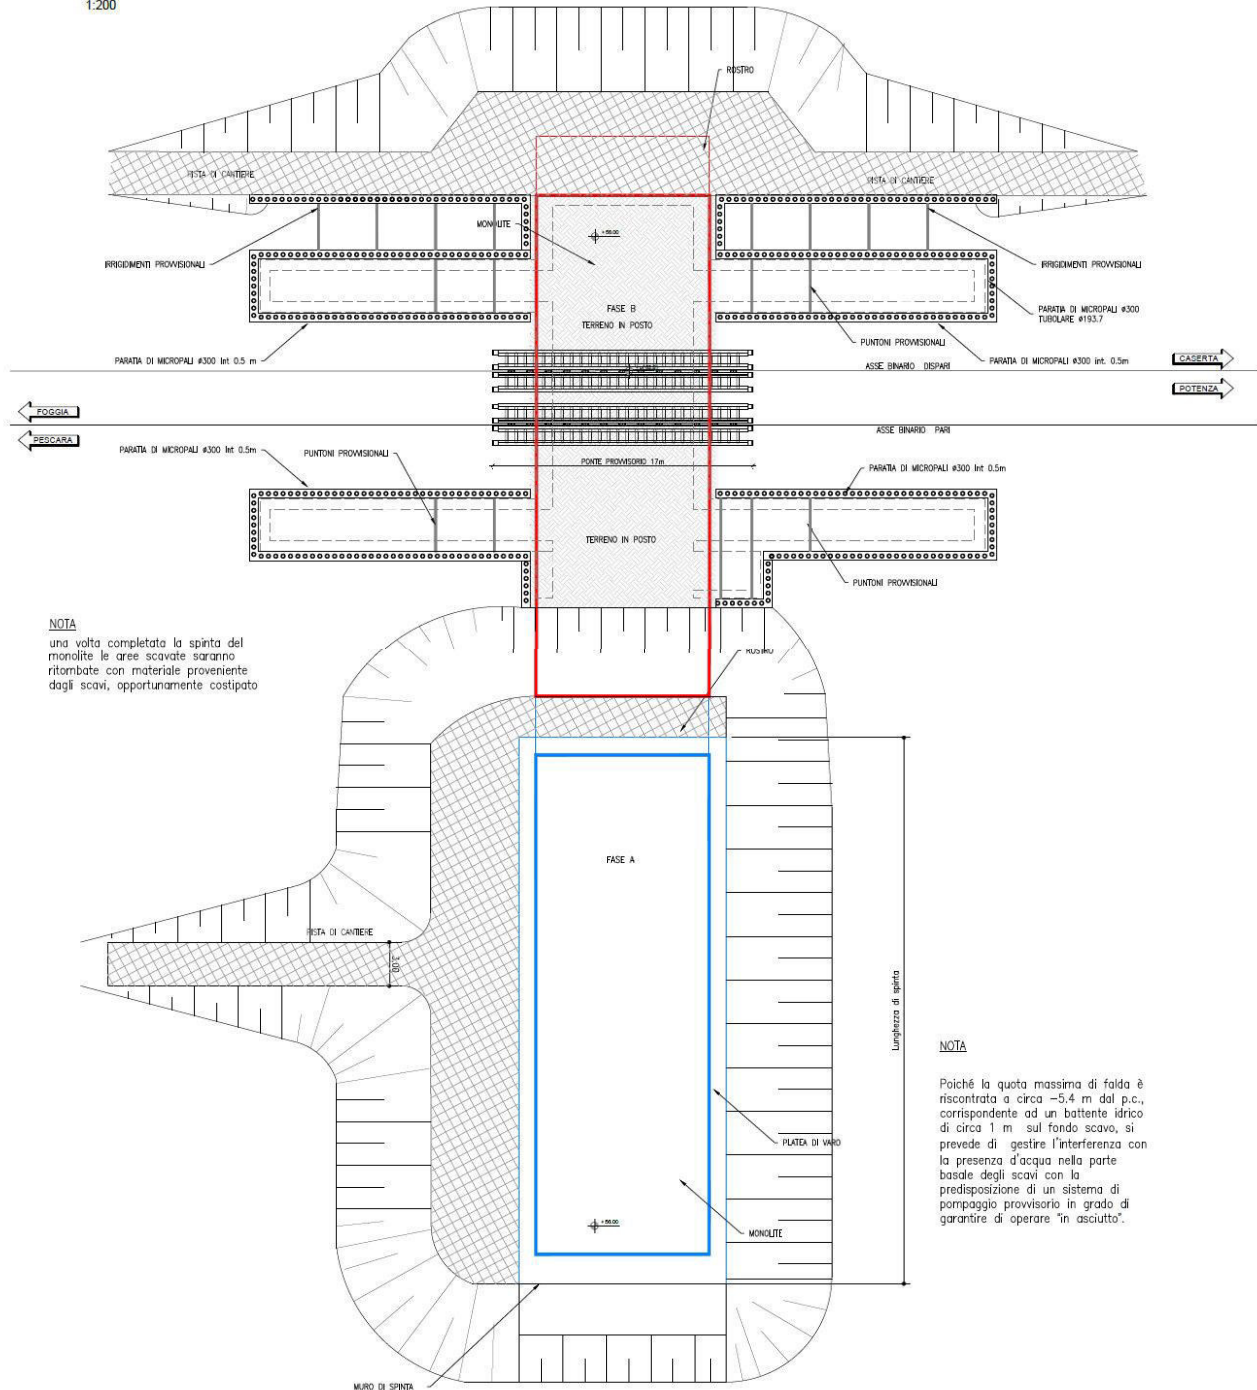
Stralcio planimetrico Monolite a spinta e platea di varo
